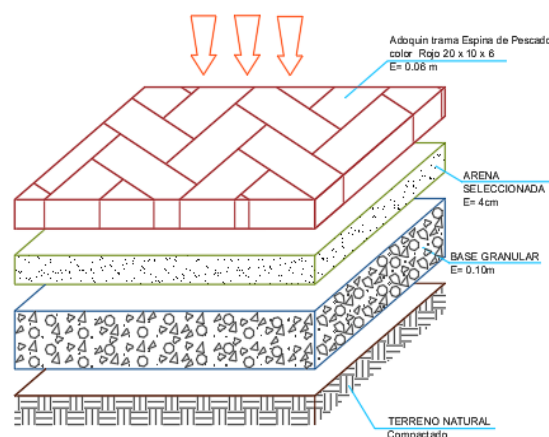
Sección típica de adoquinado – estructura de capas
